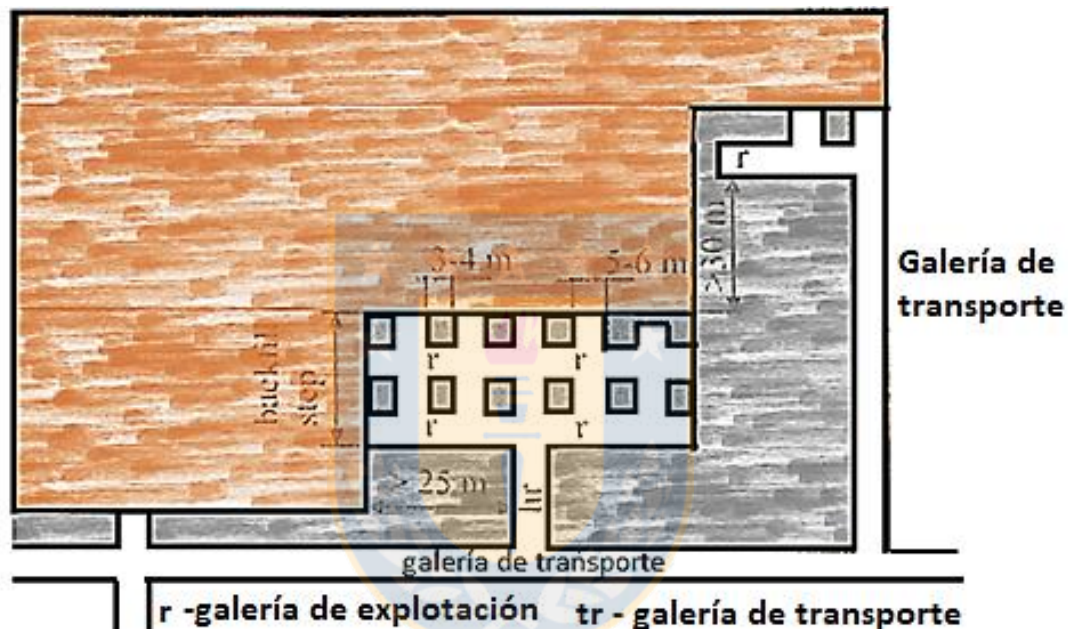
Room and Pillar (imagen referencial, vista en planta).
